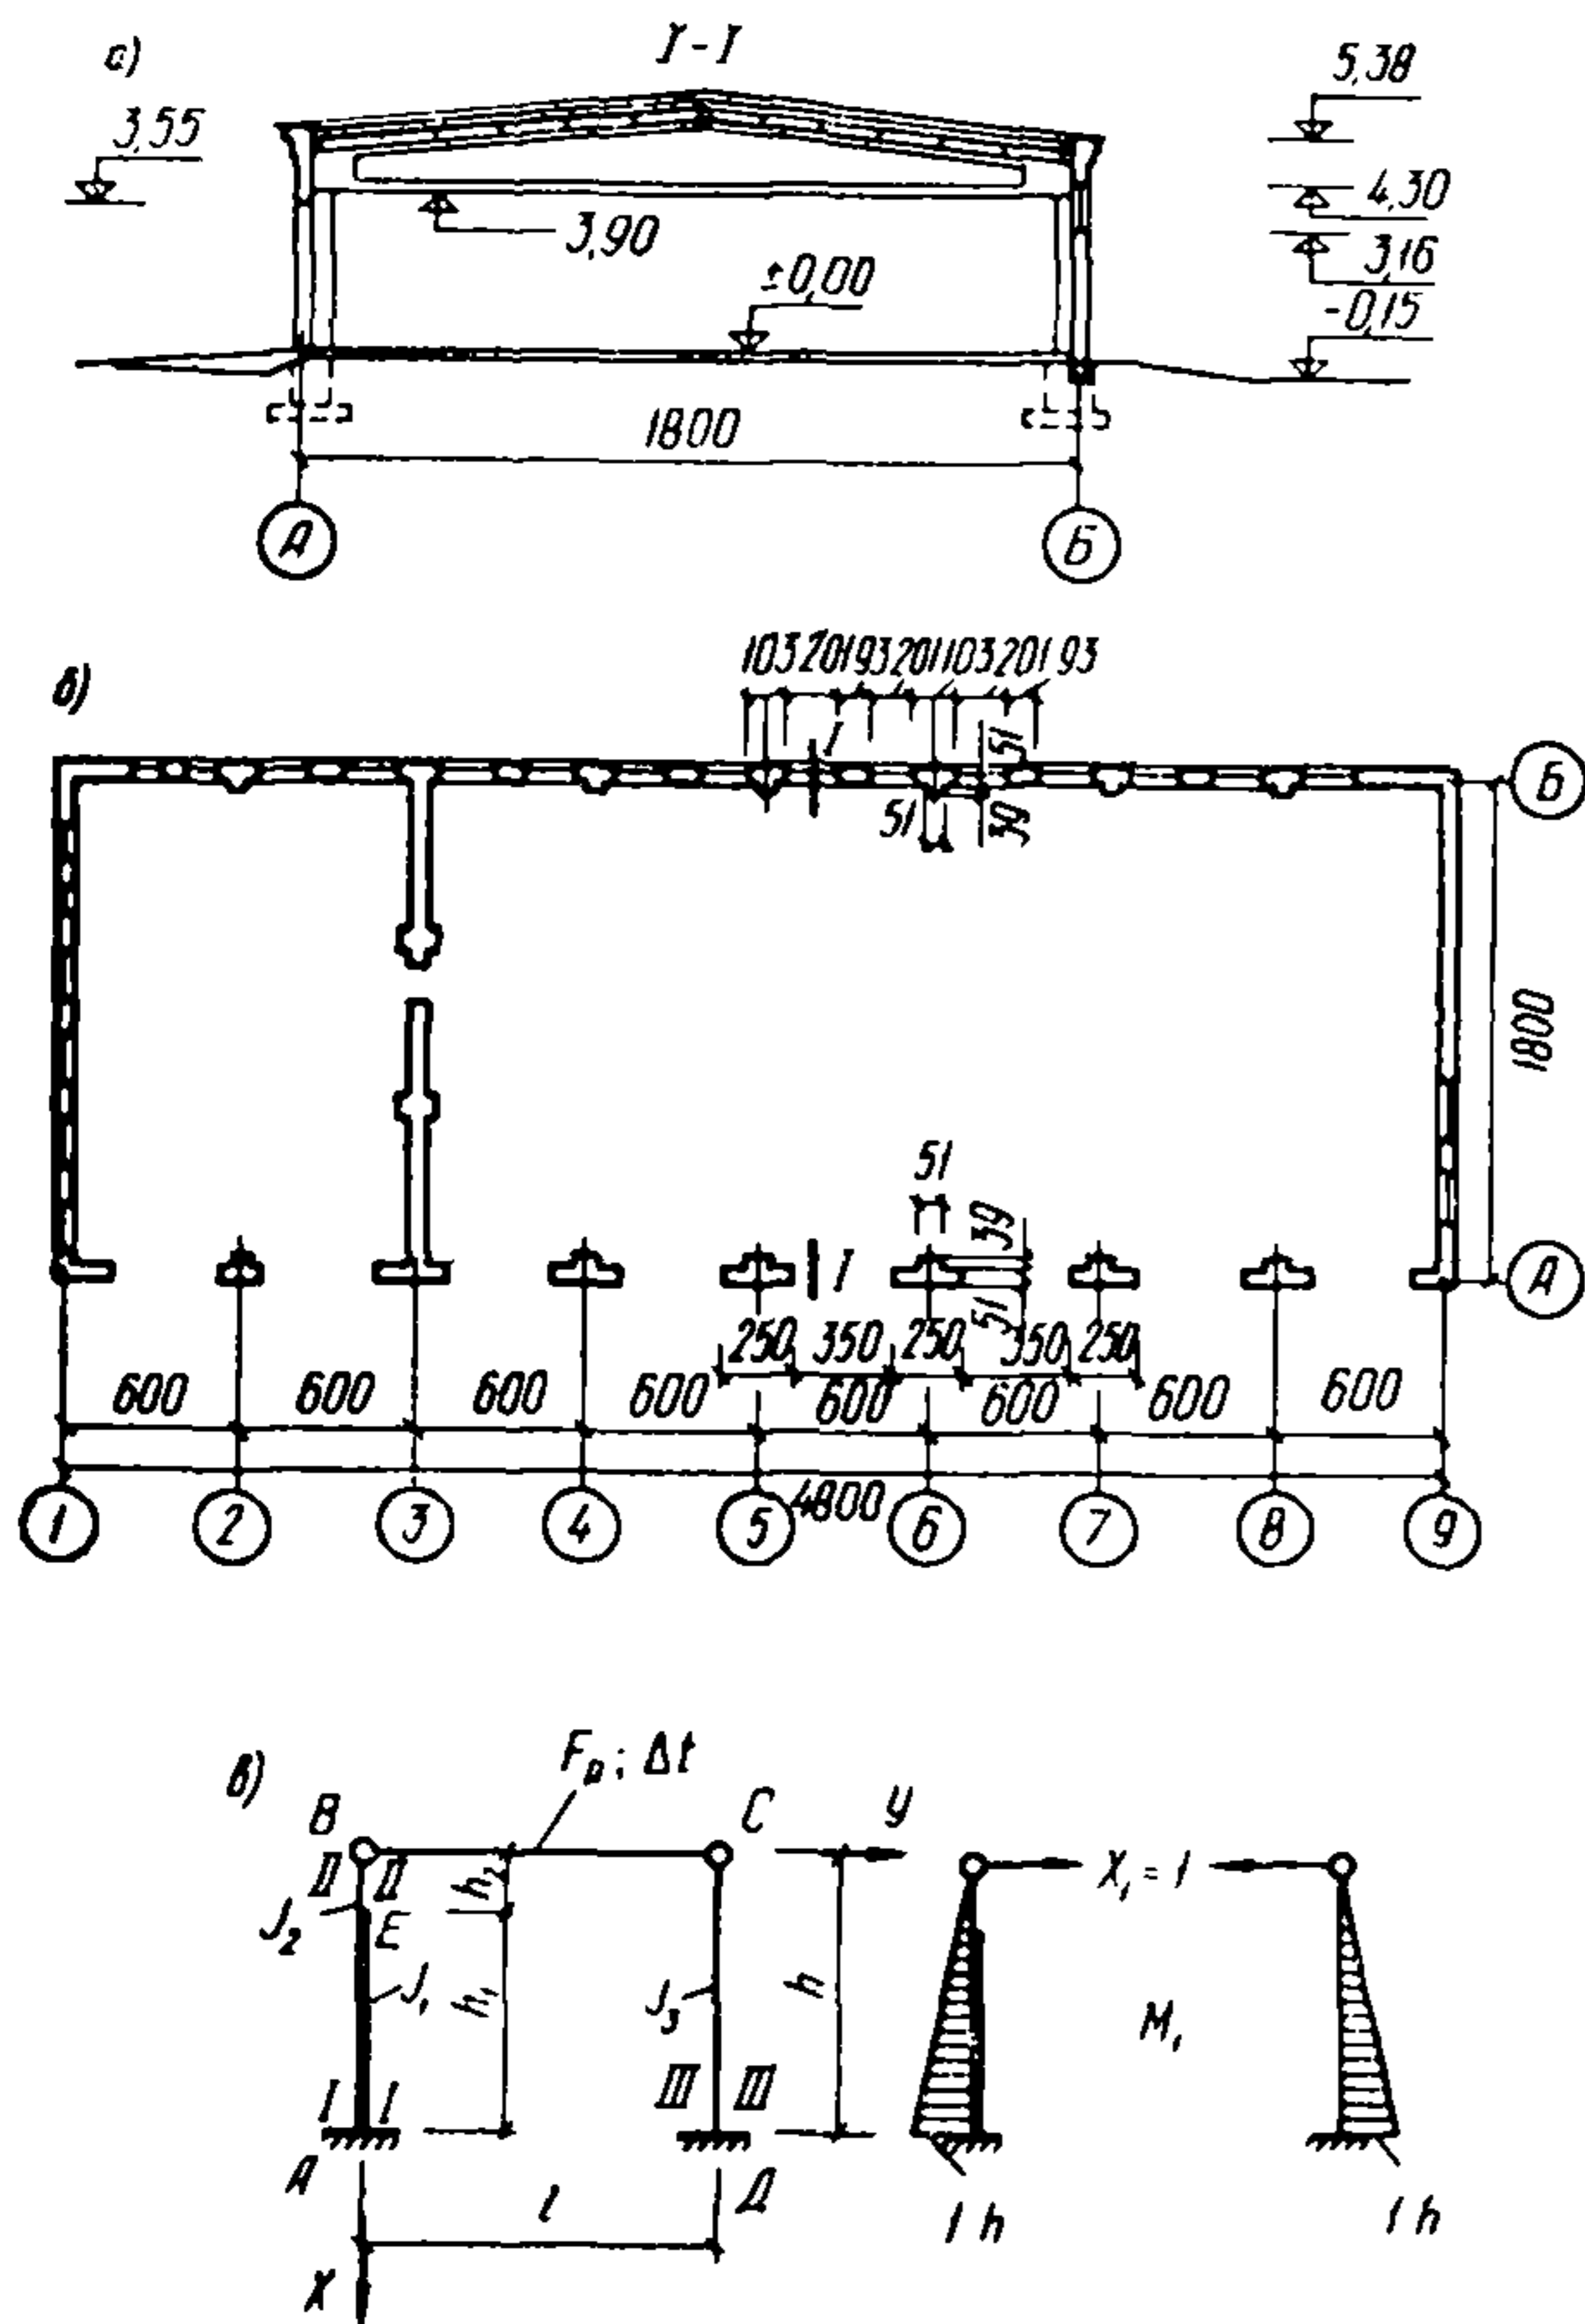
К расчету температурных усилий в стенах и перекрытии одноэтажного промышленного здания
